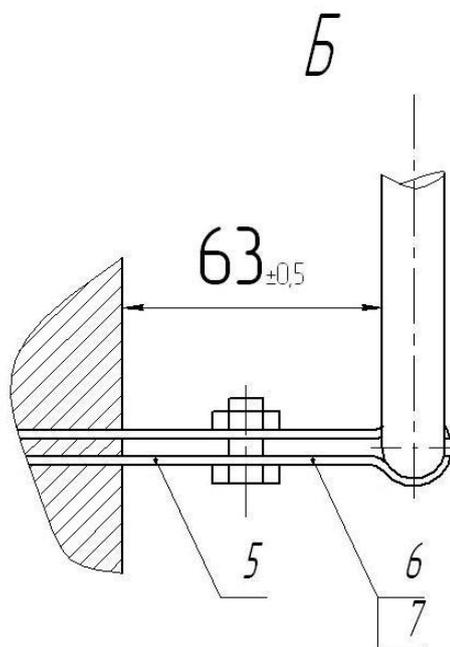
Схема водопровода внутриквартирного, вид Б
